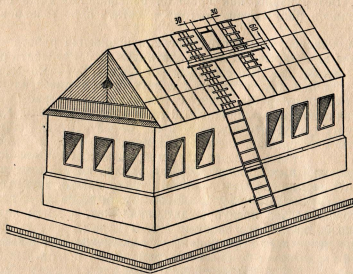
Схема устройства рабочего места для кладки оголовка трубы.
